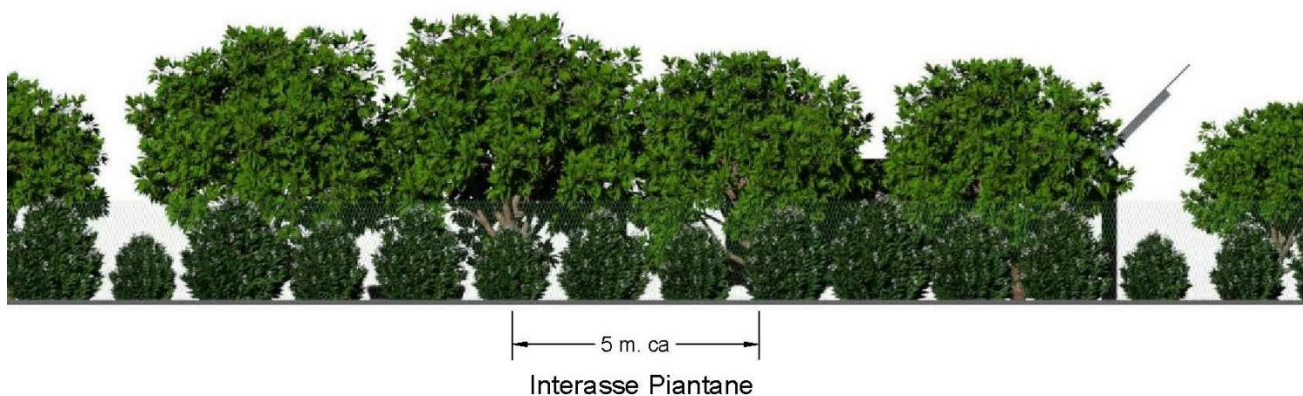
Esempio prospetto recinzione perimetrale con mitigazione
